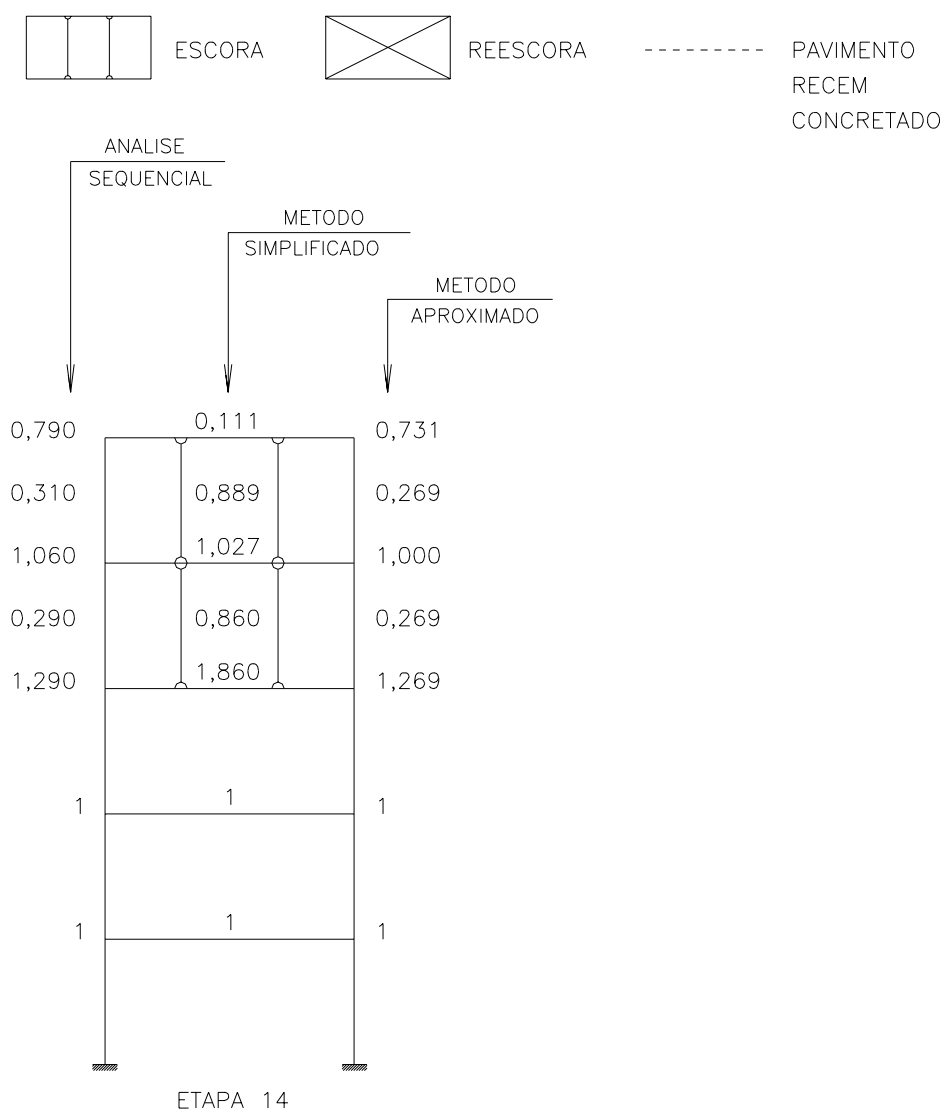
Distribuição das ações de construção segundo fatores de carga k ($x G$)
